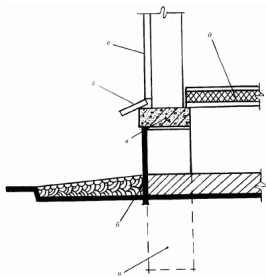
Устройство столбчатого фундамента в доме с теплым полом: а – фундаментный пол; б – забирка; в – железобетонная перемычка; г – сливная отмостка; д – теплый пол; е – стена.
